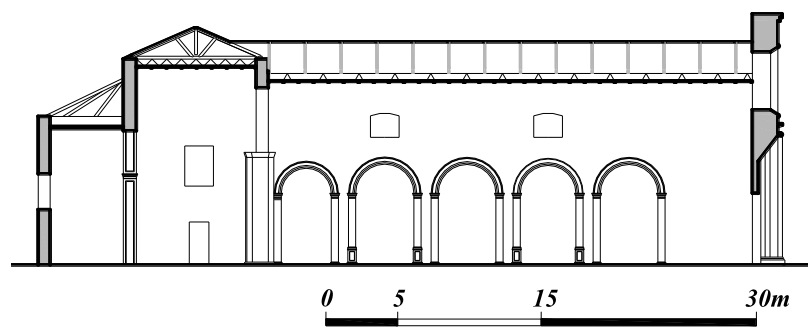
Chiesa di S. Giusta: Sezione longitudinale
